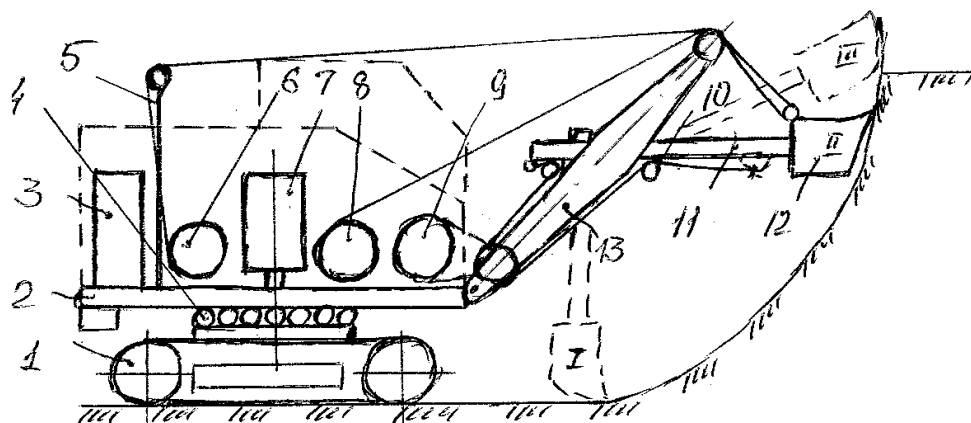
Одноковшовый экскаватор с прямой лопатой и механическим приводом.
